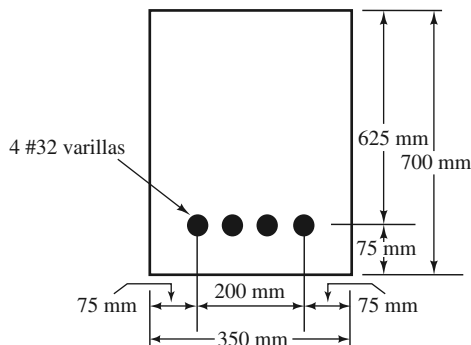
Sección transversal de la viga del ejemplo 3.5.
